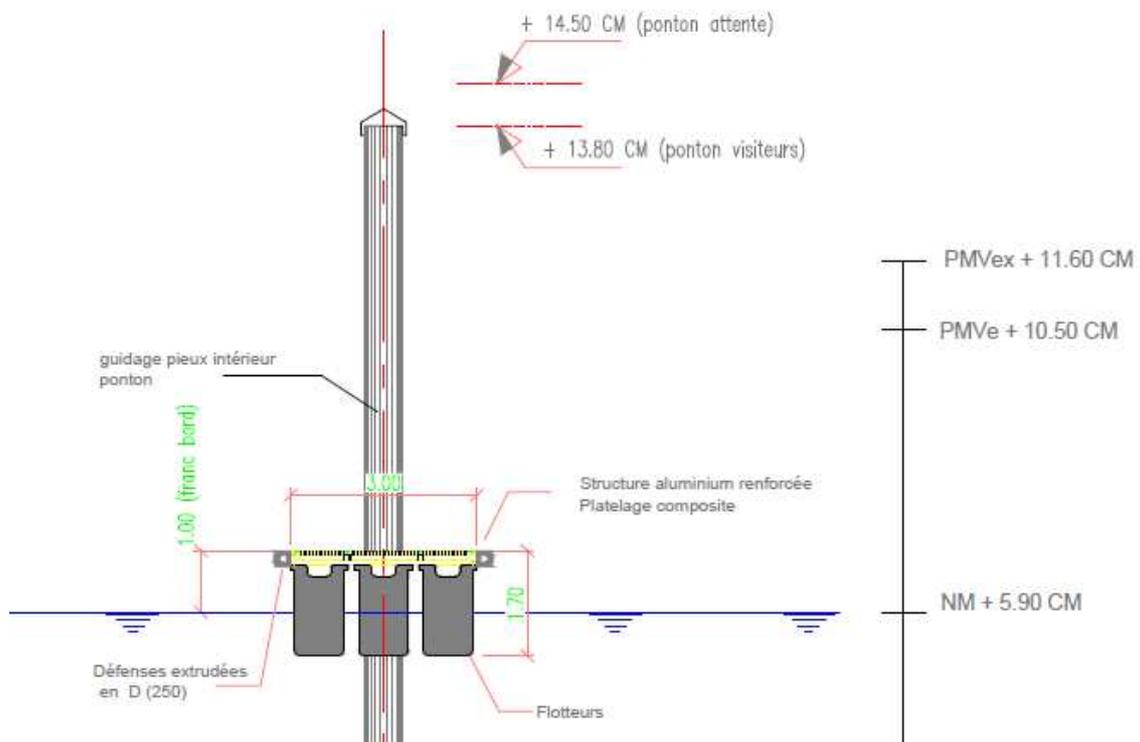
Rehaussement du franc-bord du ponton renforcé à 1 m
